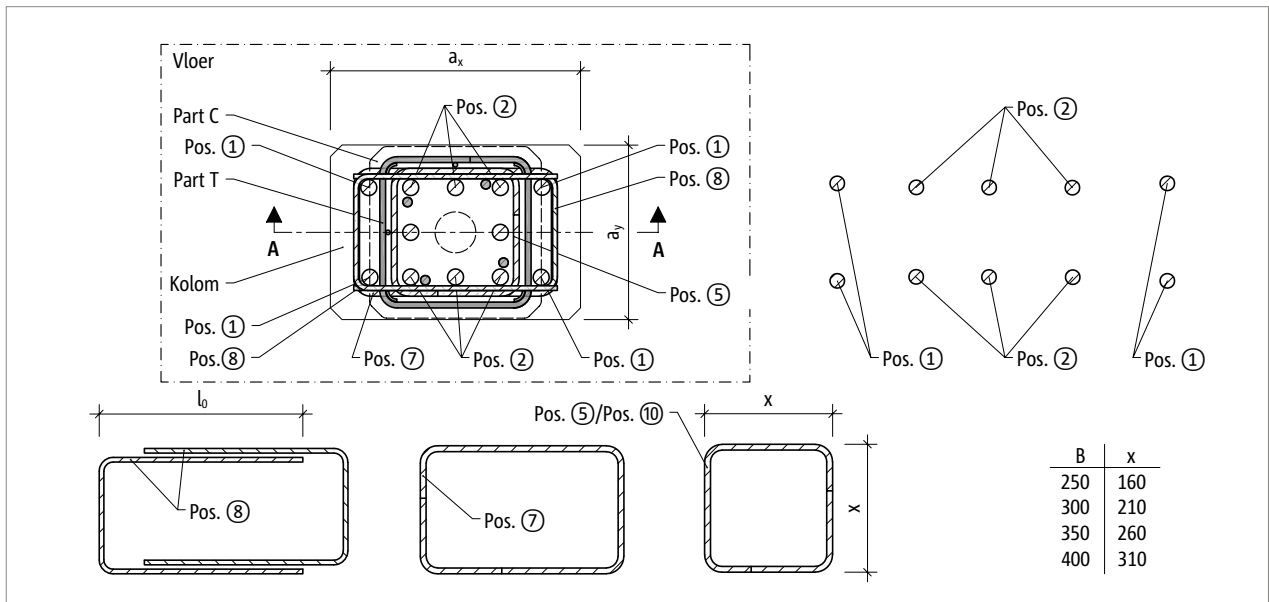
Schöck Scconnex® type P: bijlegwapening in de kolomdoorsnede
